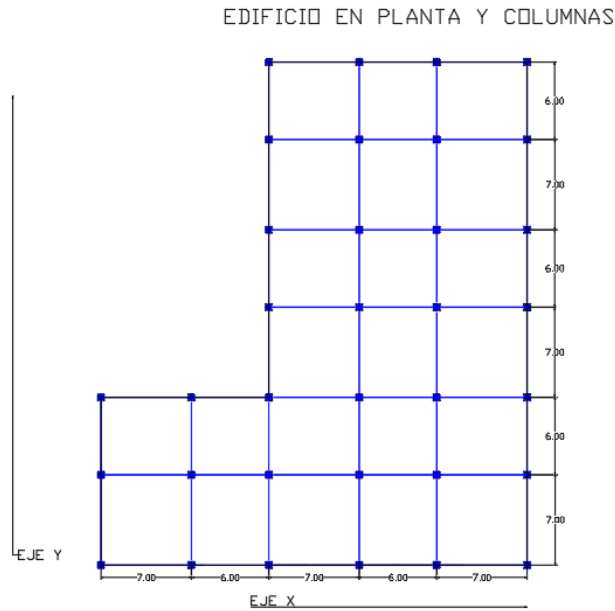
Modelo 2 en planta y Distribución de columnas.
